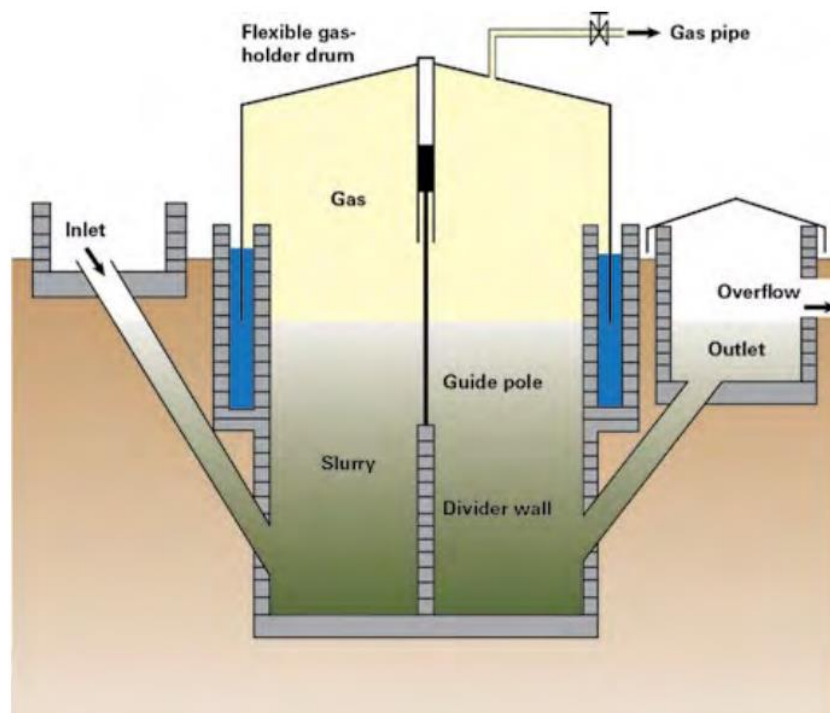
Схема біогазової установки з плаваючим покриттям [37].
